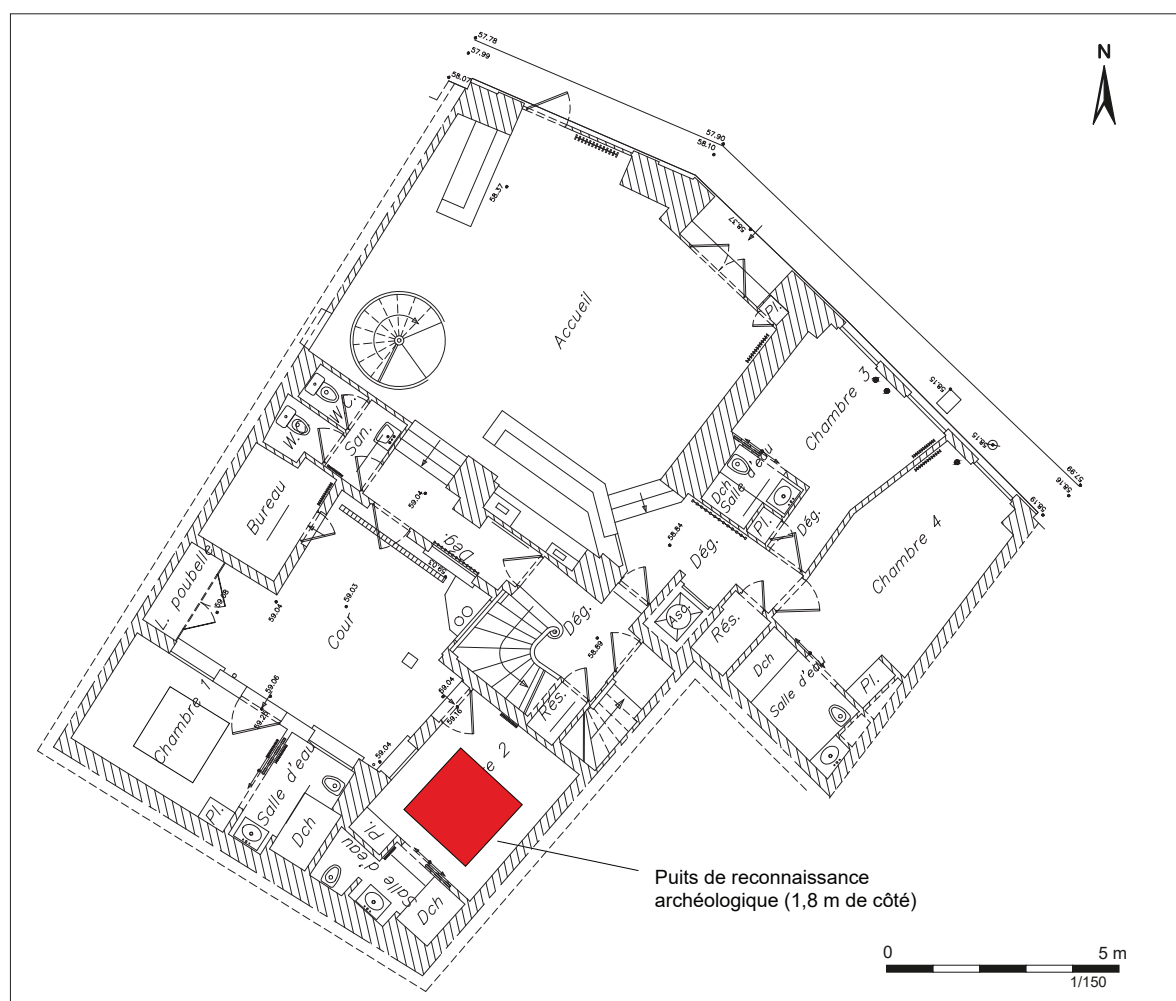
Plan du rez-de-chaussée existant avec localisation du sondage archéologique.
